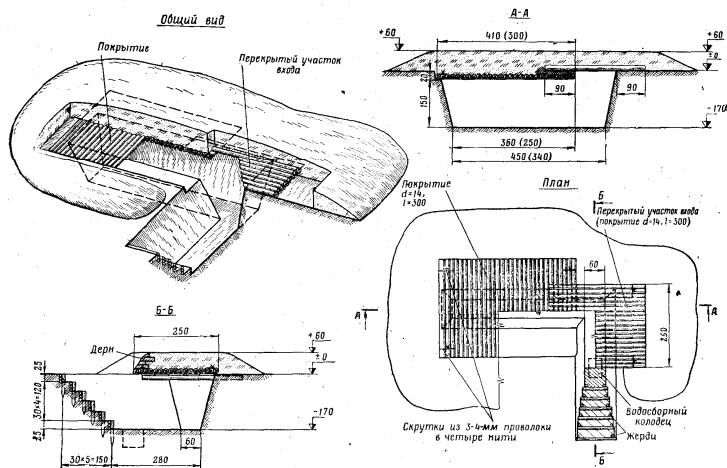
Перекрытая щель на расчет из 8 (4) человек: объем вынутаго грунта со входом с поверхности 13,5 (11,5) м<sup>3</sup>, со входом из траншеи 10,5 (8,5) м<sup>3</sup>
